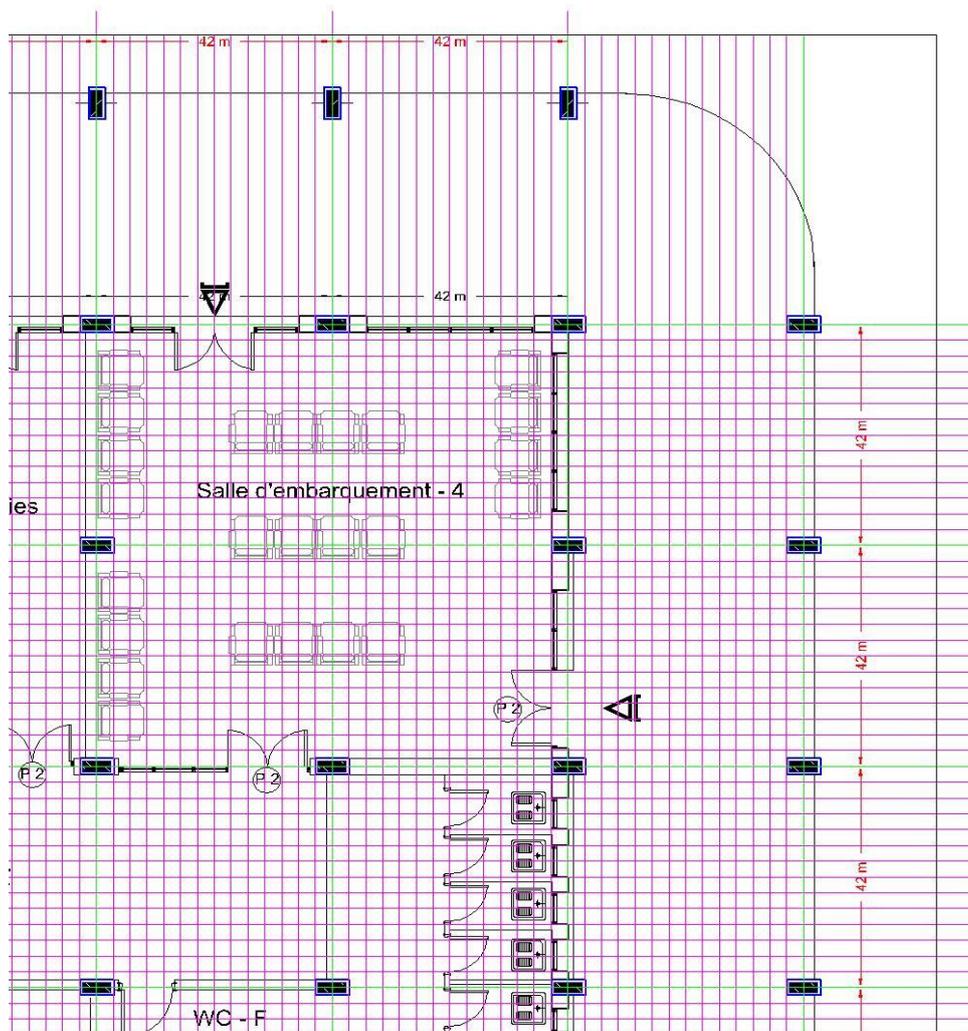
Implantation horizontale des poutres et poteaux en béton armé
